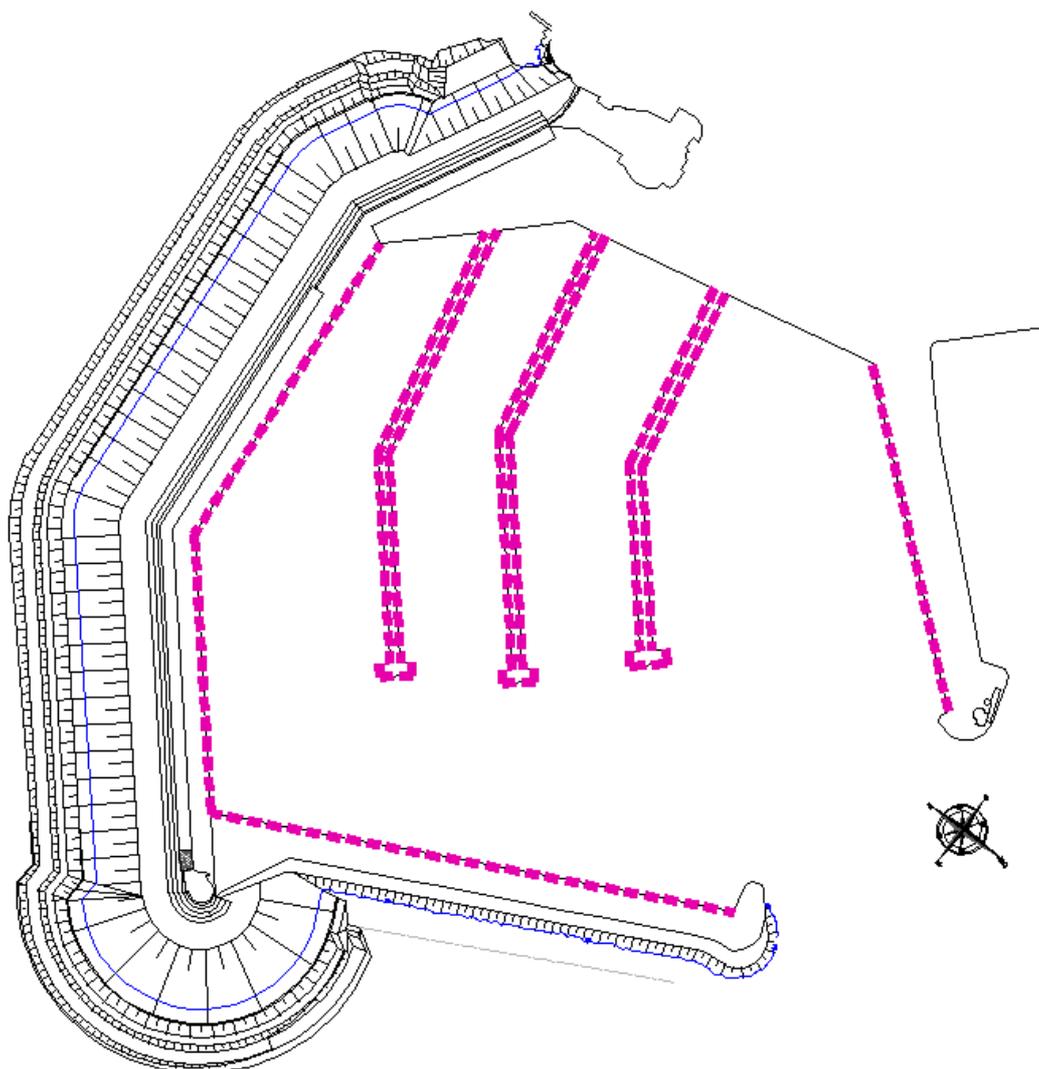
Planimetria con indicazione delle banchine ormeggiabili
